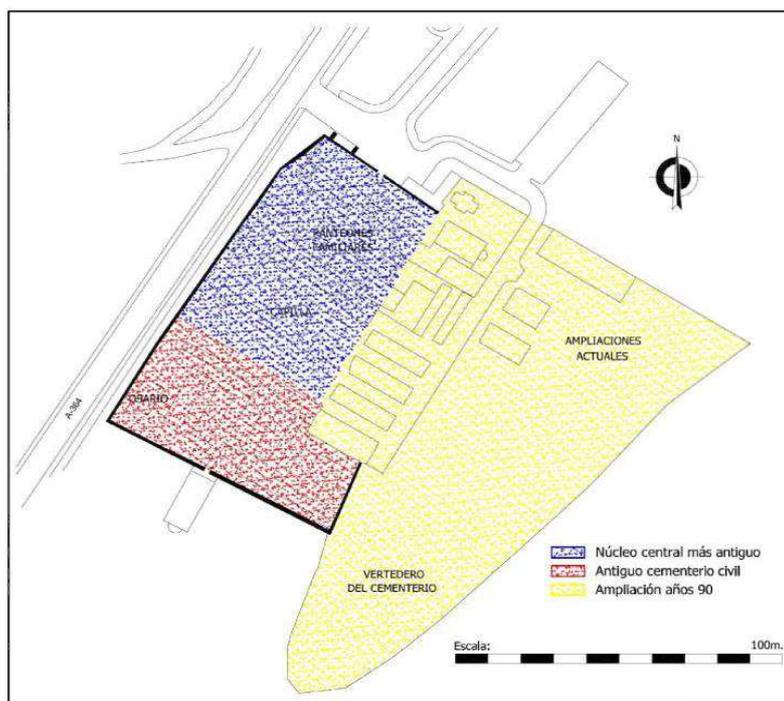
Planta actual del cementerio y zonificación. Fuente: Gavira Berdugo, M. A. (2014).
